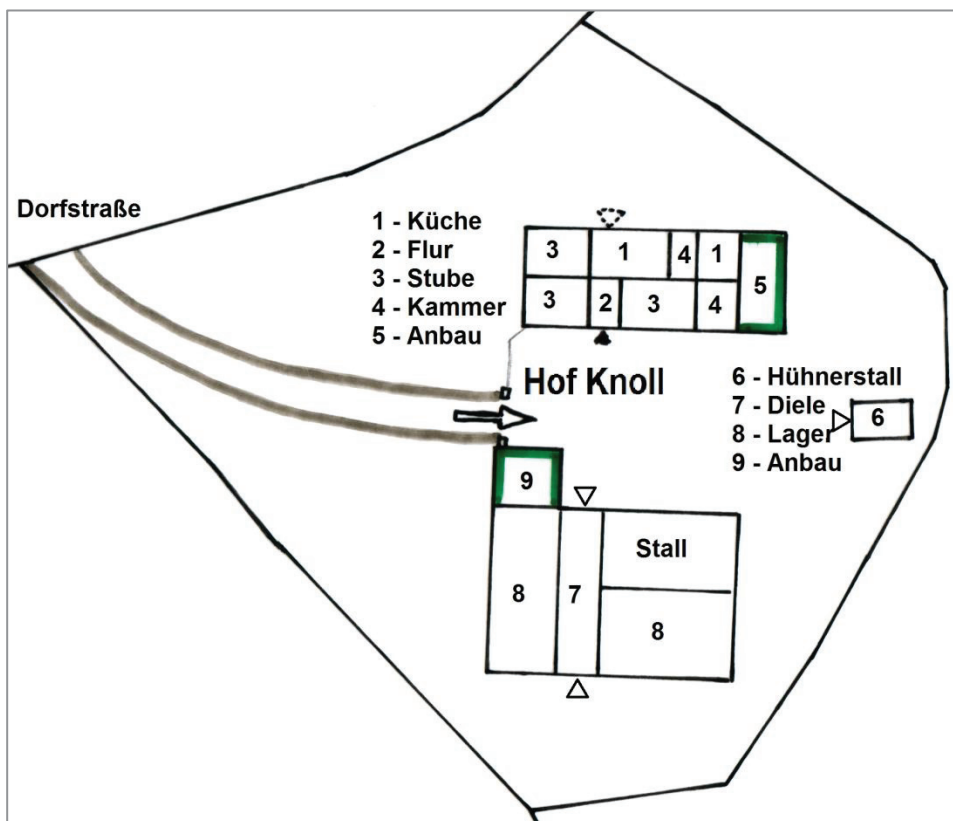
Skizze Grundstück 6, ehemaliger Hof Knoll mit Gebäudegrundrissen
